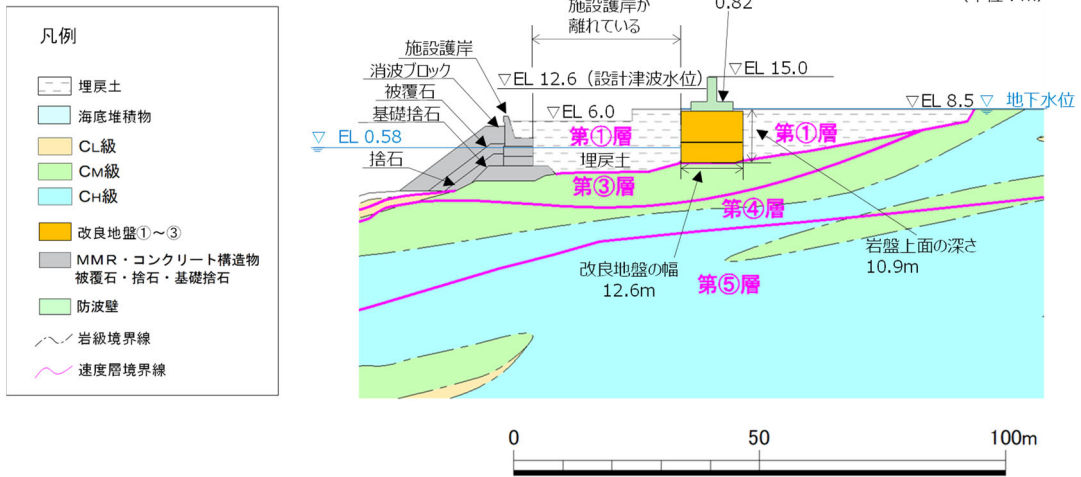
防波壁（逆 T 擁壁）の横断面図（①-①断面）
